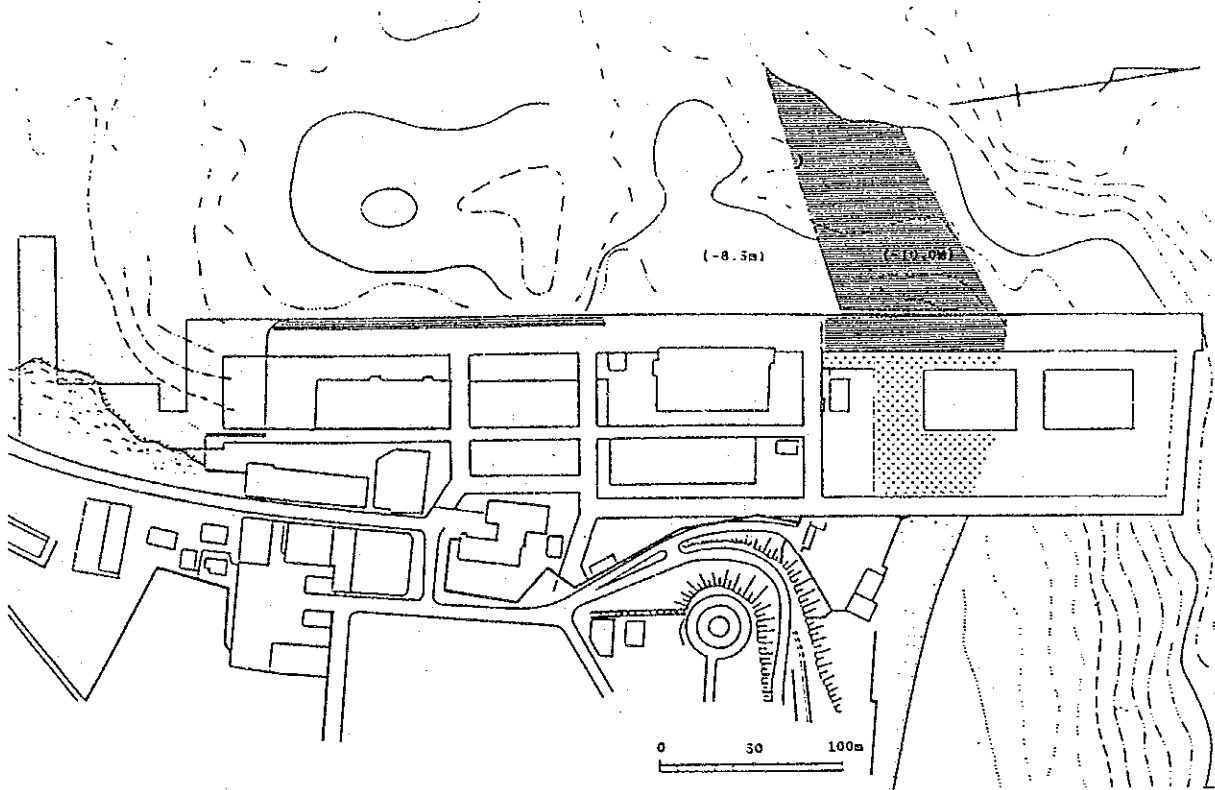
(1) Avancement des Travaux de Construction à la Fin de 1995
